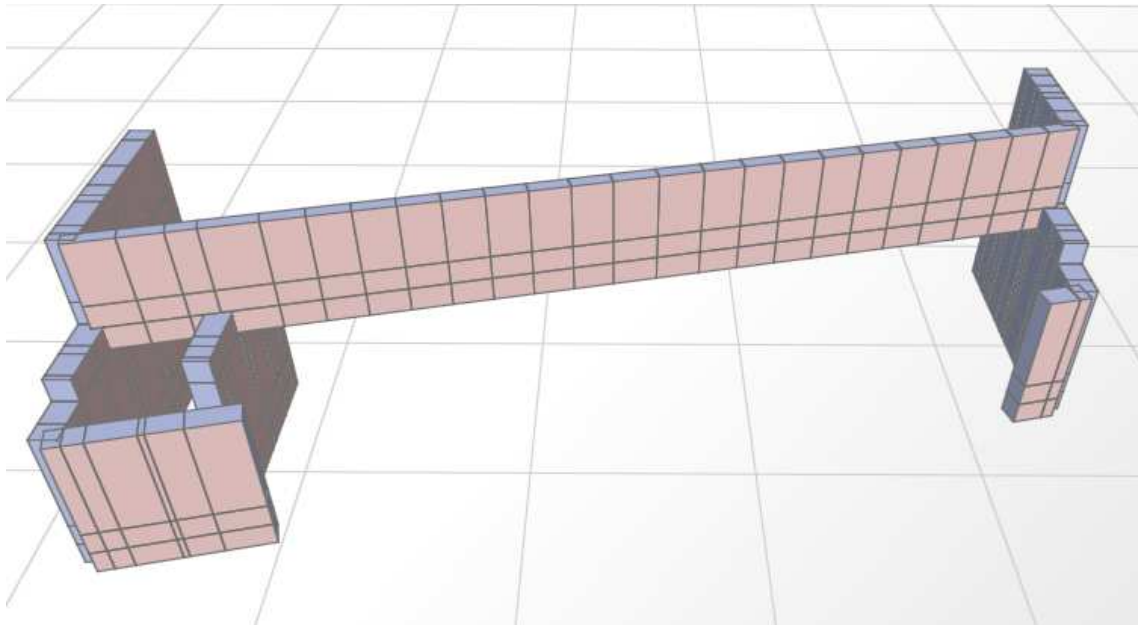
Vista 3D paraghiaia, spalle, risvolti
